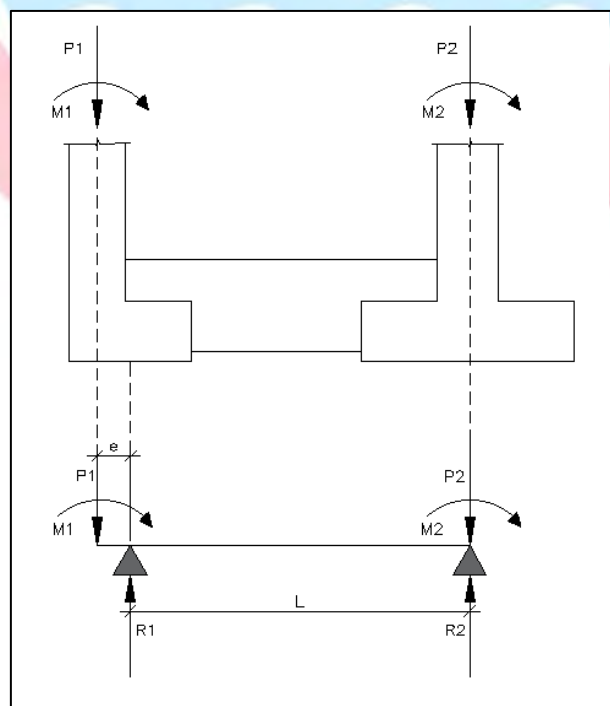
Modelo de viga simplemente apoyada en las bases de las zapatas.
